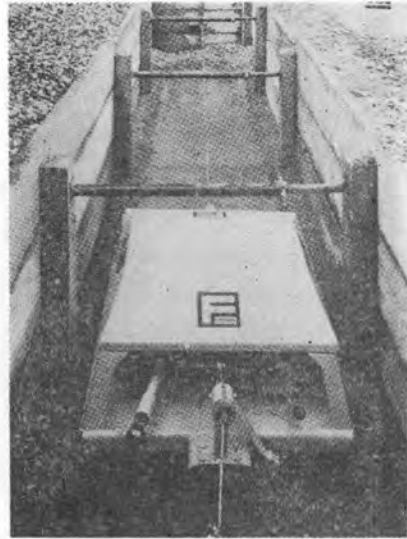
溝の埋戻し, 締固めを施工中の自動振動プレート
